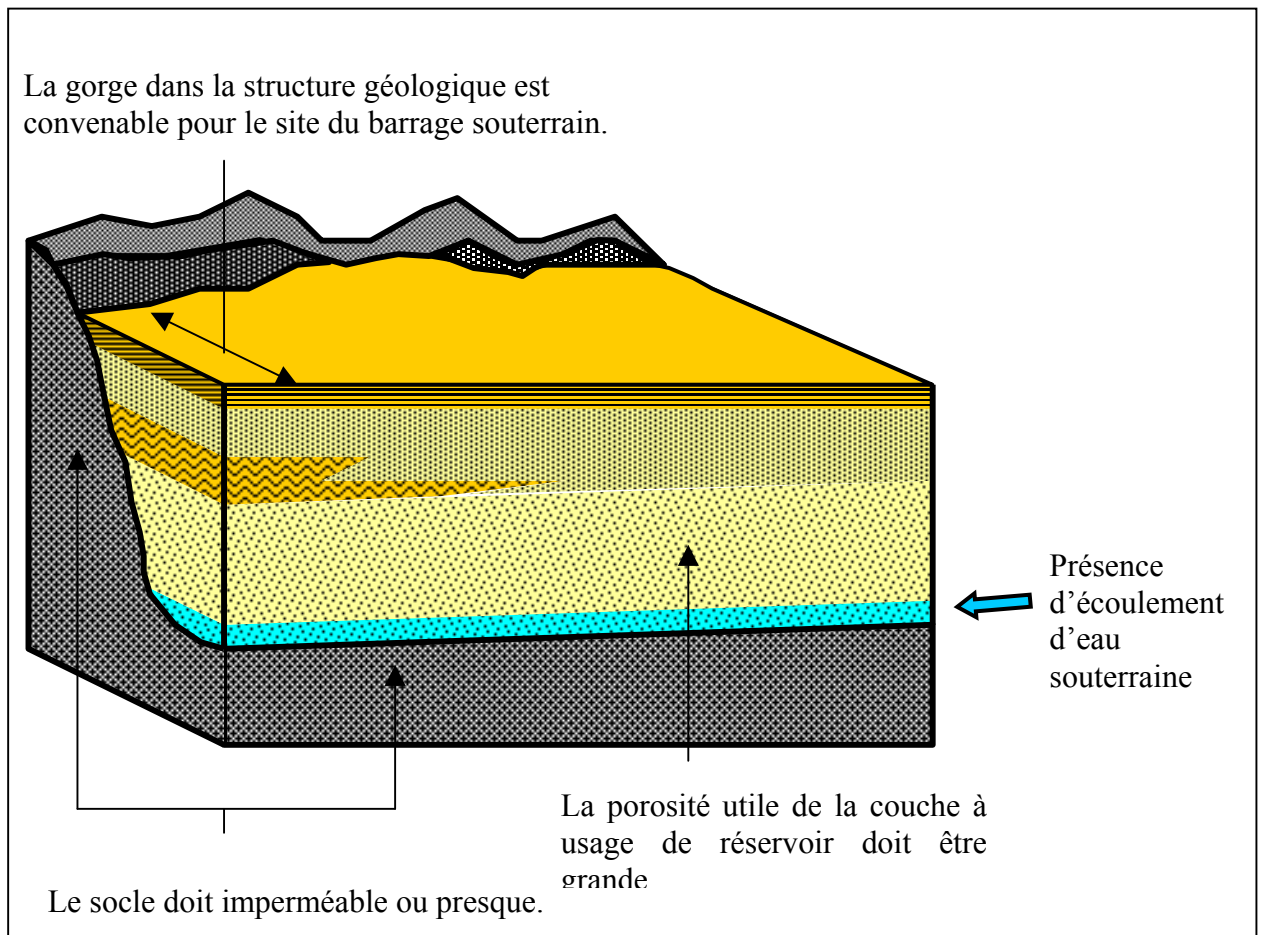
Conditions convenables pour le site de construction du barrage souterrain
